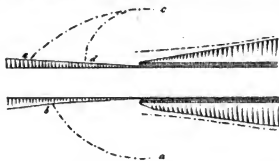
Schnee-<sup>40)</sup>ausführung an den Einschnittsenden <sup>41)</sup>.
